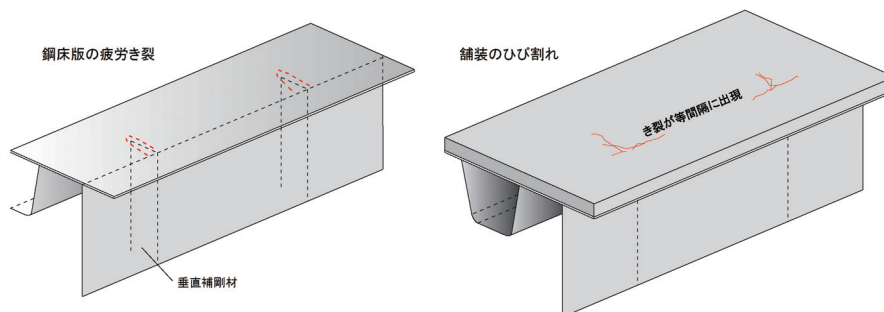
デッキプレート貫通き裂と舗装のひび割れ
